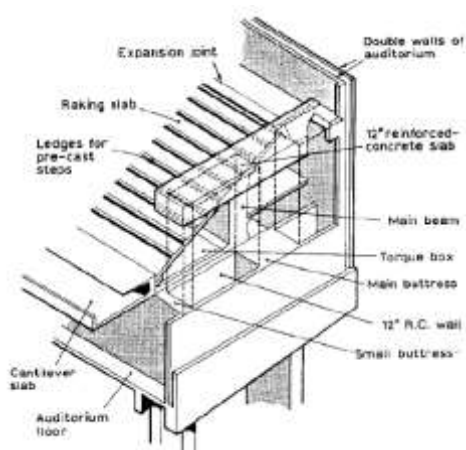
Corte transversal da viga caixão triangular que suporta a laje em consola [17]
